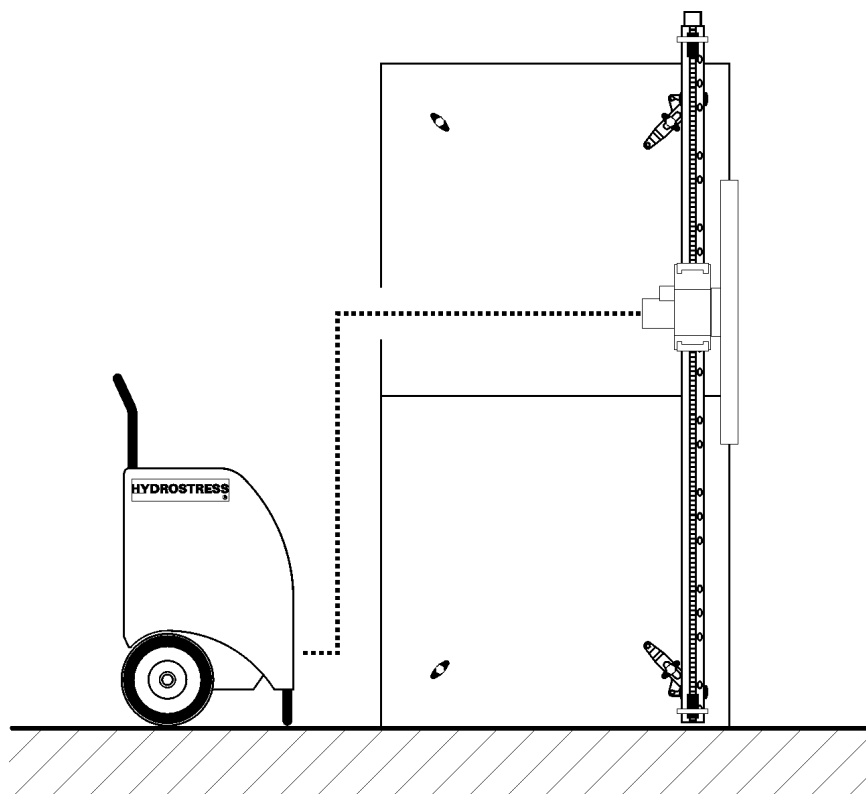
Conectar grupo de accionamiento con la Cortadora de muro
